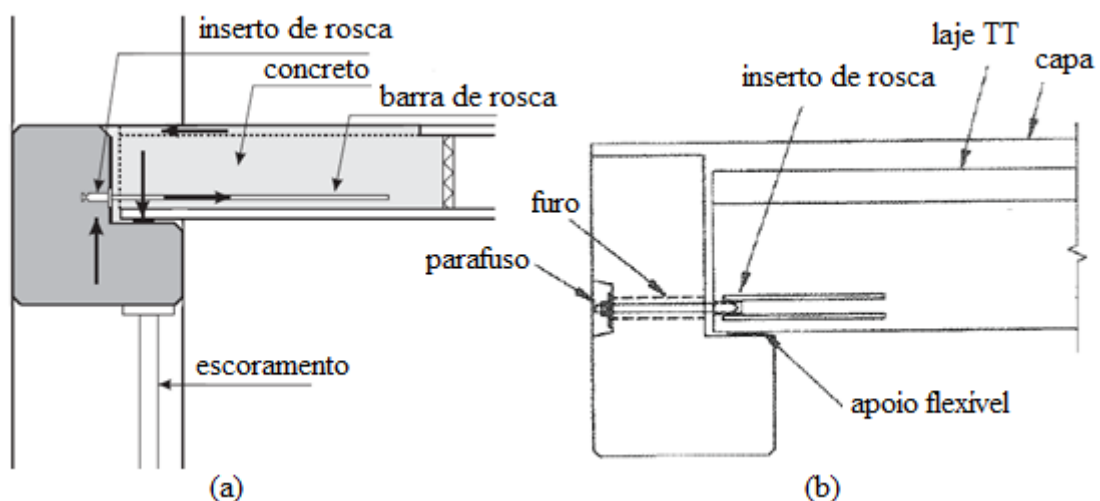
Ligação viga-laje com restrição à torção, (a) laje alveolar, (b) laje TT [FIB, 2008].
